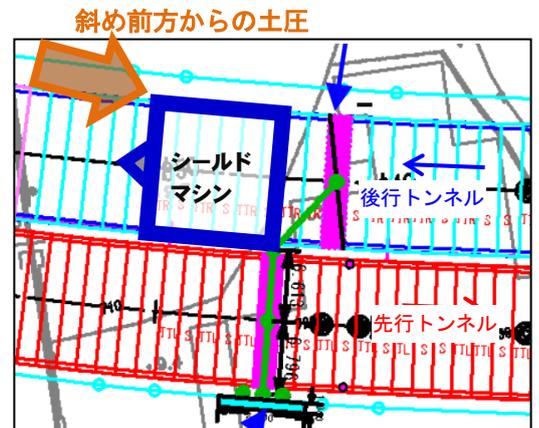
計測断面付近の平面図および最大作用圧発生時の後行シールド位置図
